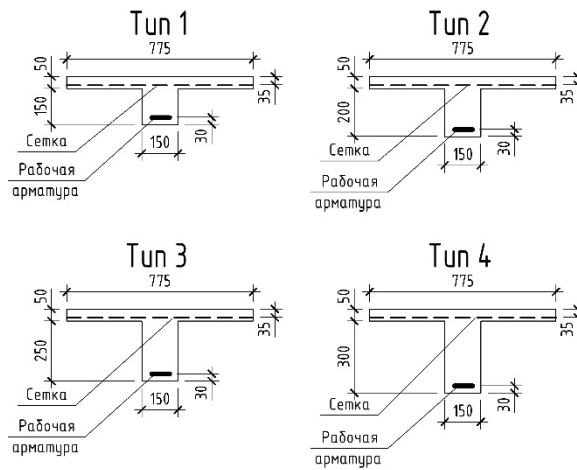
а. Вариант 1. Расчетные сечения для определения пролетного армирования
